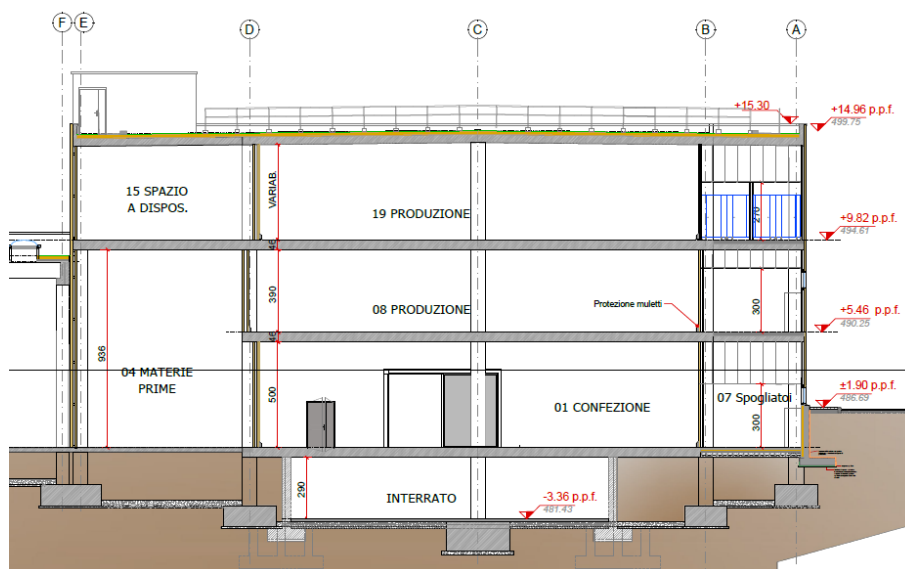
Sezione architettonica D-D - Fabbricato Ex. Piemonte
